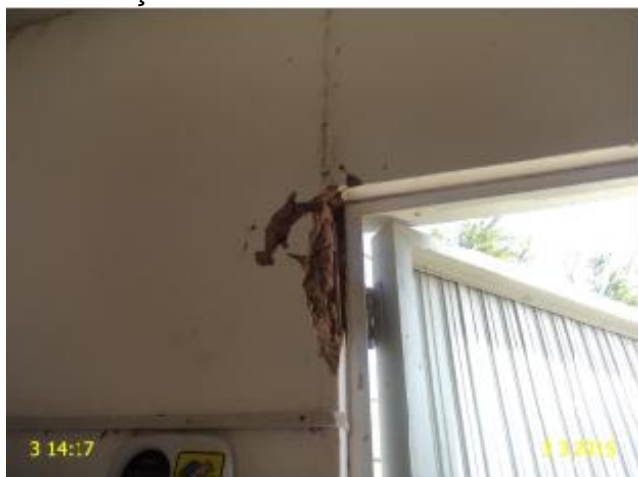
EEE-01 Baixa Preta: estrutura deteriorada.
